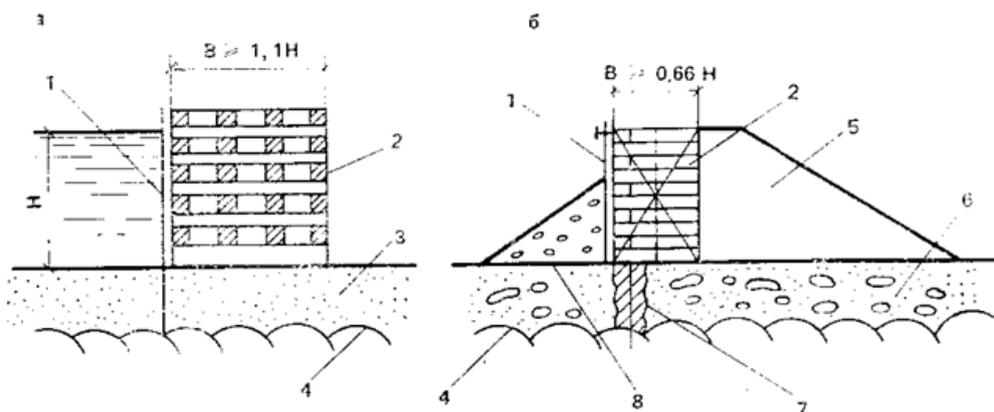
Ряжевые перемычки: а – с широким ряжем; б – с узким ряжем; 1 – шпунт; 2 – ряж; 3 – фильтрующие грунты основания, допускающие забивку шпунта; 4 – водоупор; 5 – присыпка грунтом с нижнего бьефа; 6 – фильтрующее основание, не допускающие забивки шпунта (наличие валунов); 7 – противofильтрационная завеса; 8 – присыпка трудно размываемым грунтом с верхнего бьефа (камень, горная масса)
